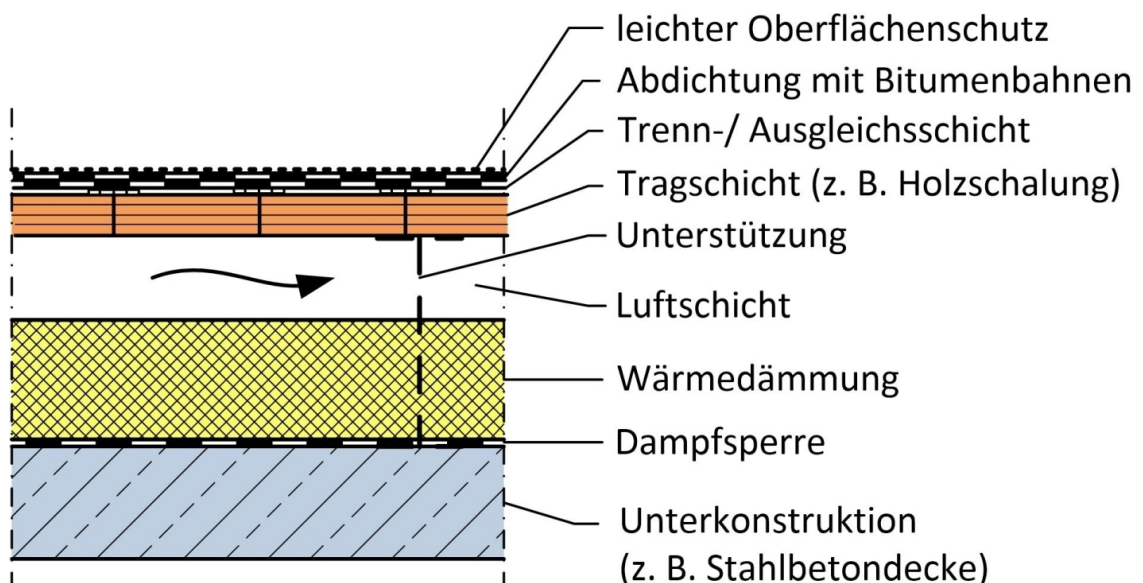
Beispielquerschnitt für ein belüftetes Flachdach (Kaltdach) (Quelle: Schmidt)
